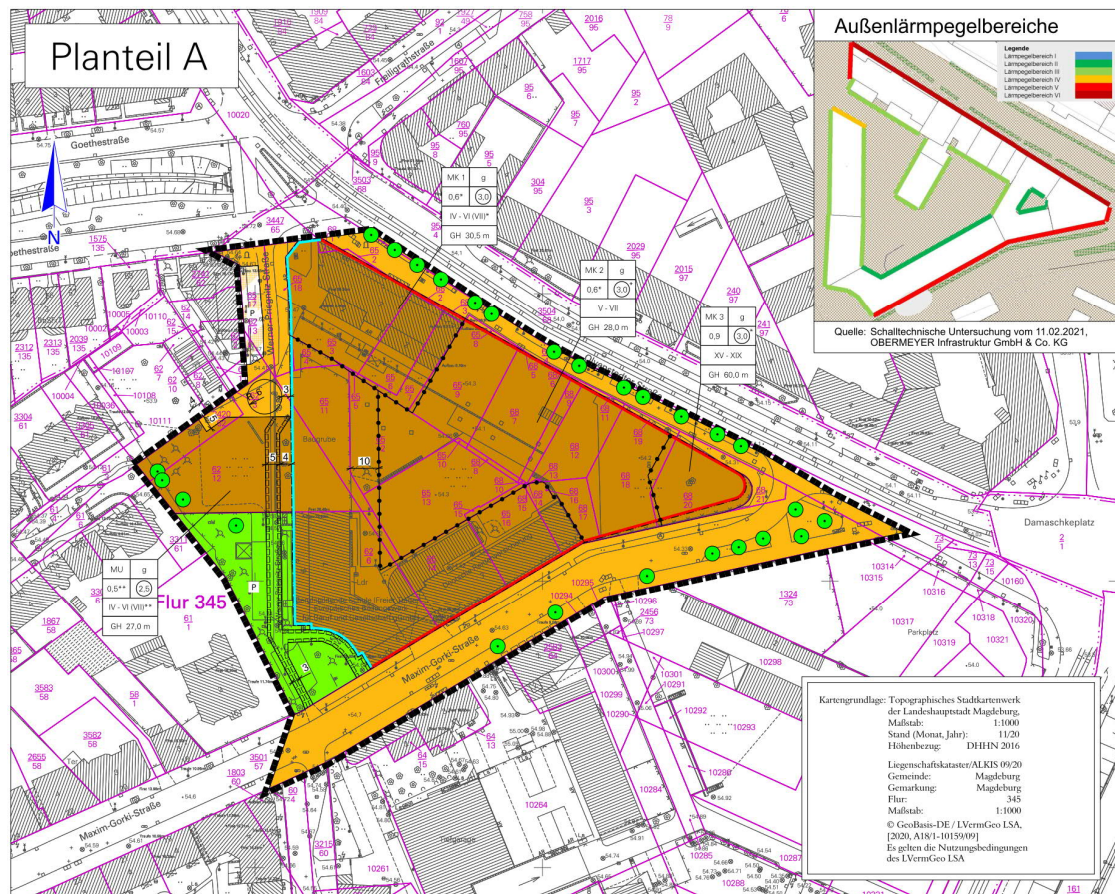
Lageplan B-Plan 216-2A [Quelle: Stadt Magdeburg 2/2021]
